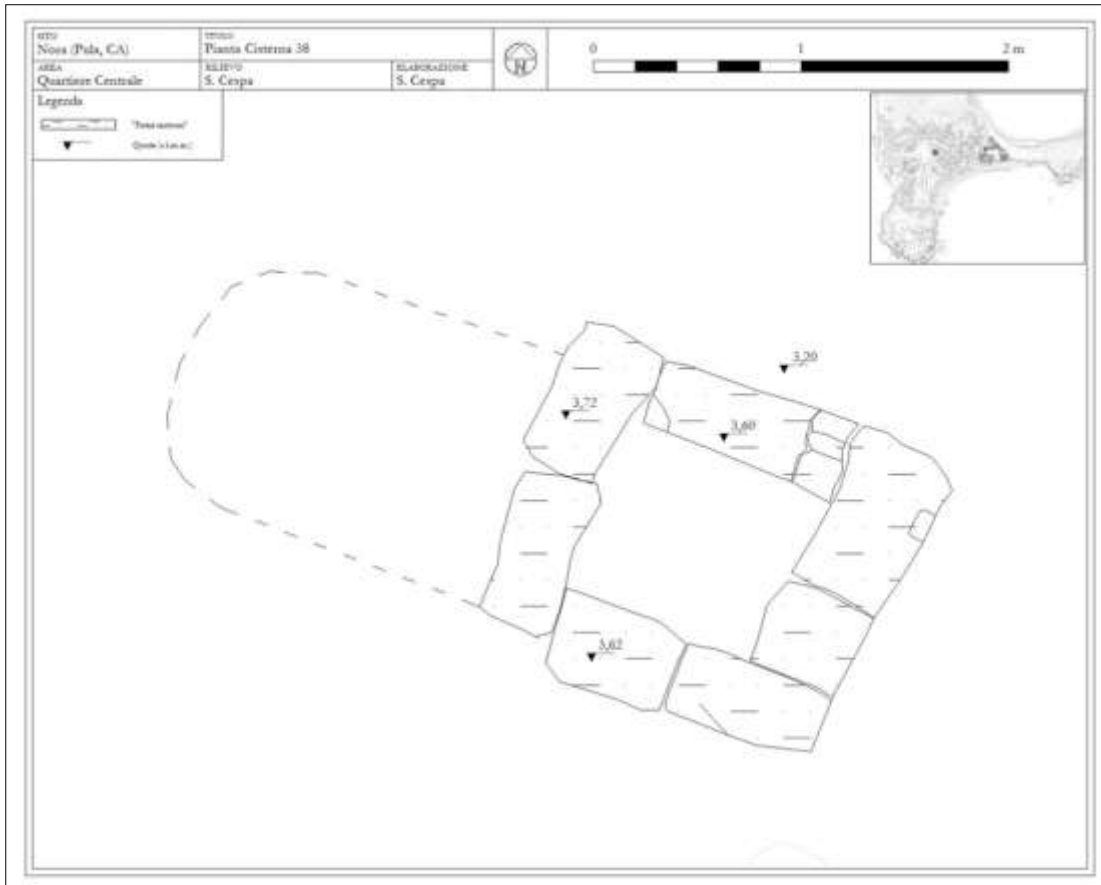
Pianta della cisterna 38 (elaborazione dell'autore).
